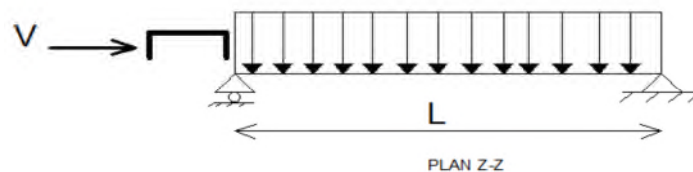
Schéma statique de la lisse dans le plan z-z.
